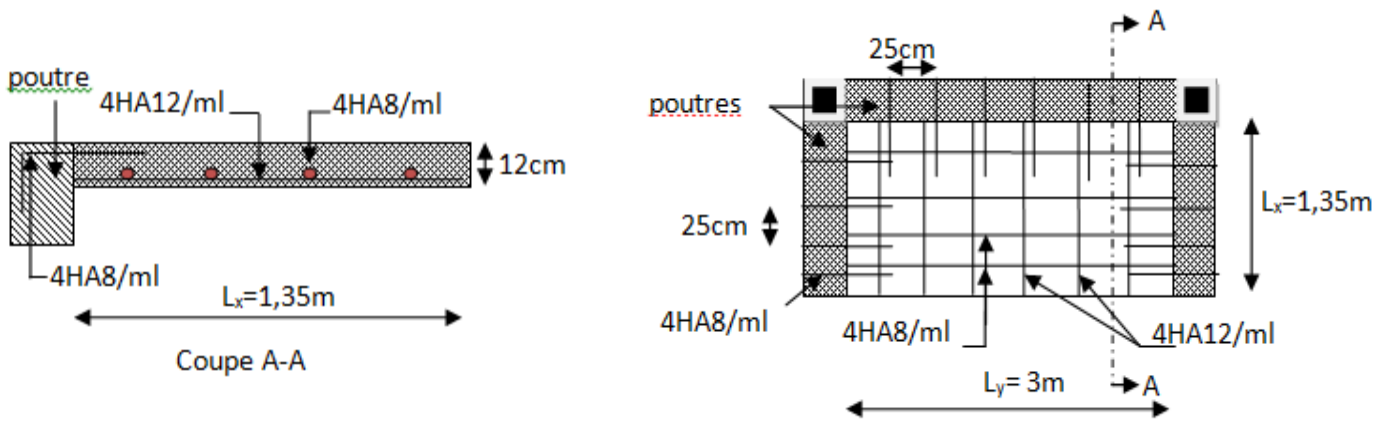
Schéma du ferrailage du panneau de dalle sur 3 appuis.
